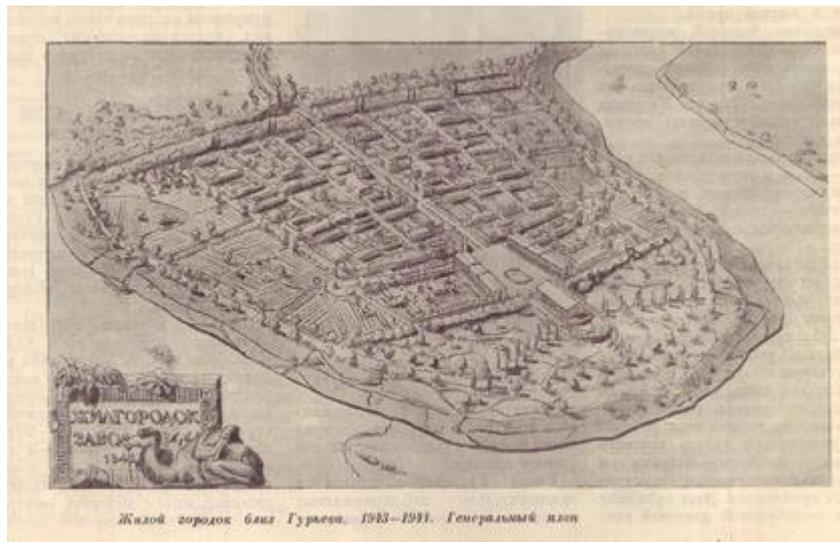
Жилой городок близ Гурьева (Атырау). Генеральный план
